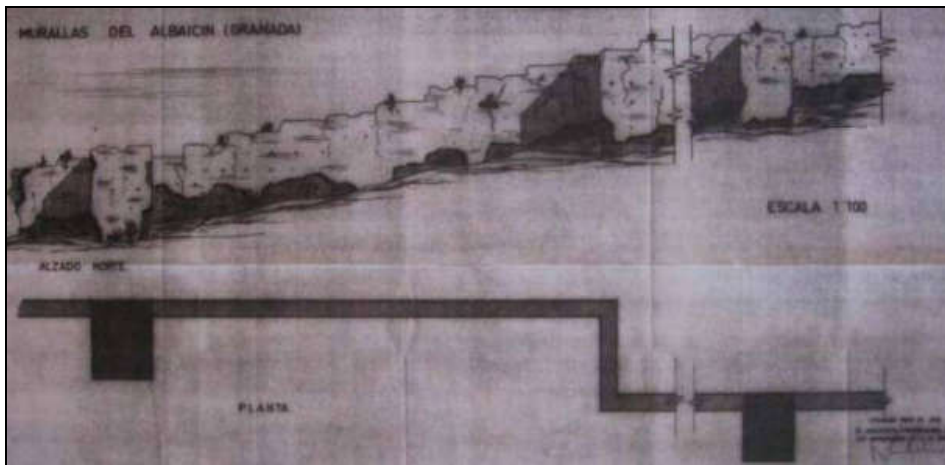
F. Prieto-Moreno Pardo, 1960. Planta y alzado Norte. Obras de recalce en el sector de la cerca de Don Gonzalo. AGA, Sección Cultura, 26/00150.
